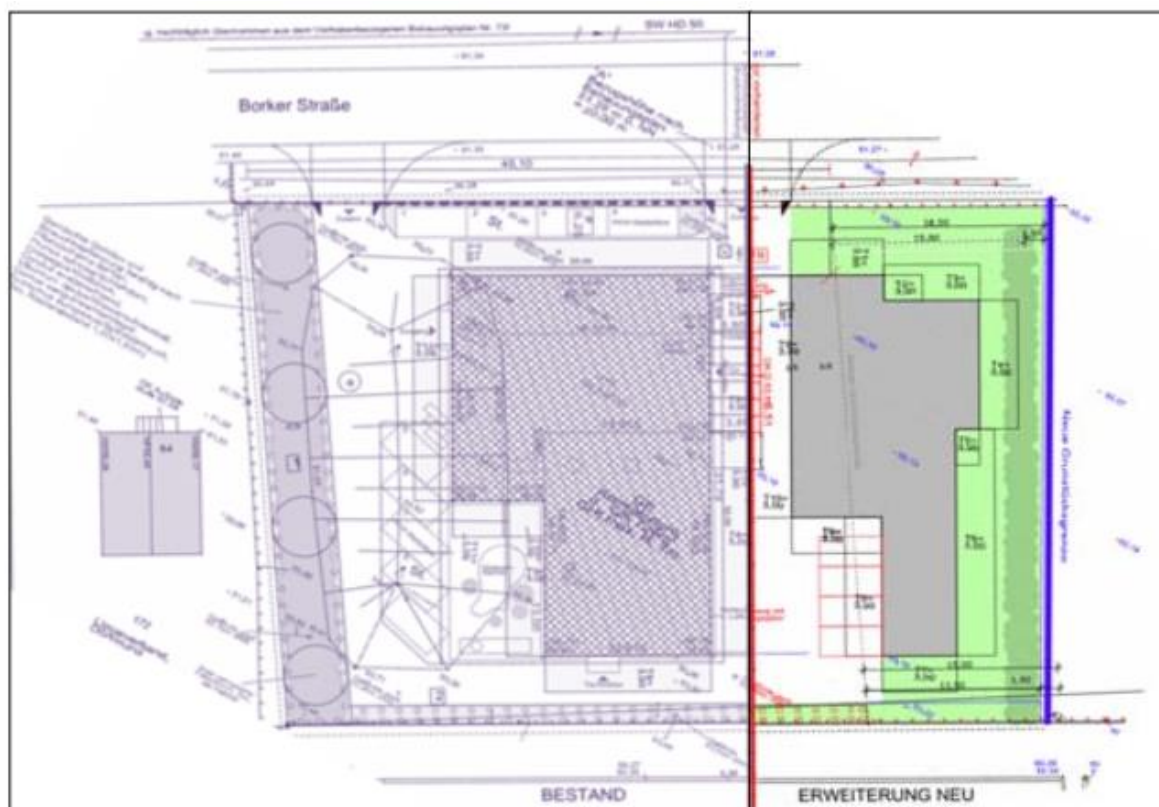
geplante Bebauung an der Borker Straße in Waltrop
